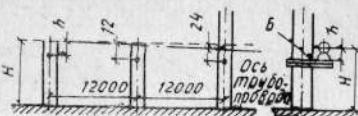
Разметка положения опорных кронштейнов трубопровода на колоннах здания
